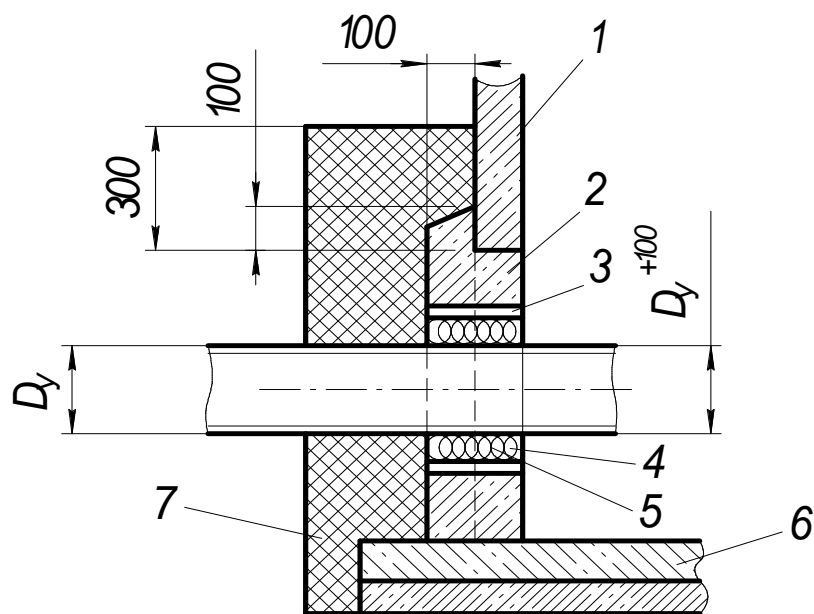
Деталь заделки труб в стенах колодцев, сооружаемых в просадочных грунтах: 1 – гидроизоляция внутренней поверхности стенок, 2 – бетон, 3 – стальной патрубко-футляр, 4 - асбестоцементный раствор, 5 - просмоленный канат, 6 - плита-днище, 7 – водоупорный замок из мягкой глины.
